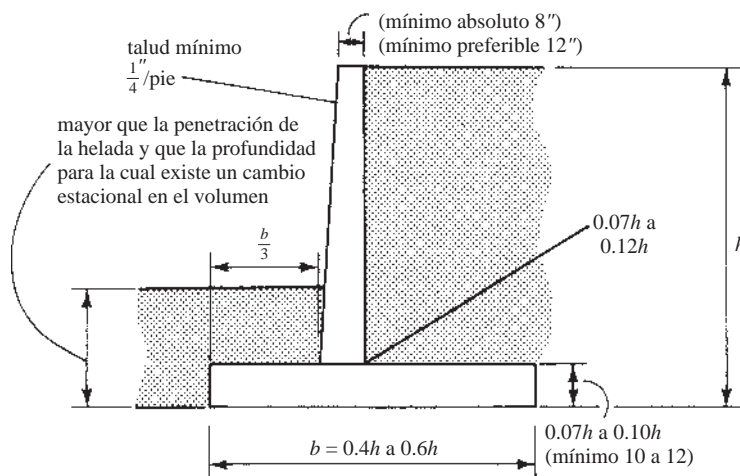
Reglas empíricas para el dimensionamiento de muros de retención tipo voladizo.
